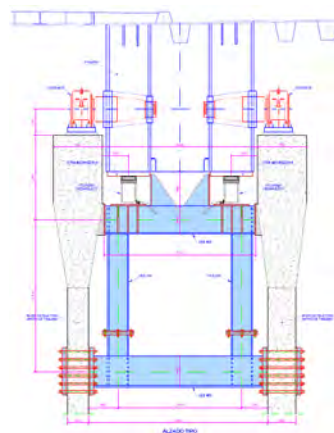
Alzado de estructura auxiliar para el izado del tablero en Puente de las Delicias.
